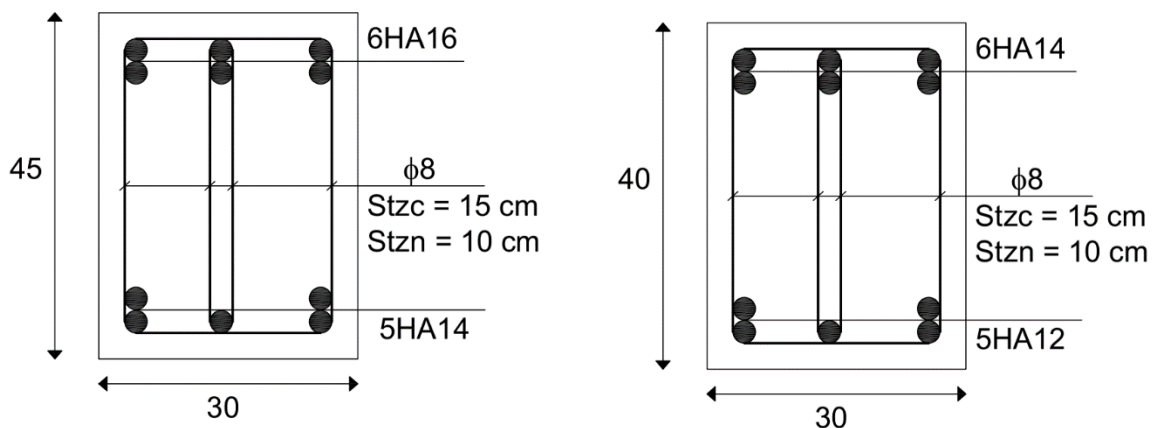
Schémas du ferrailage de la poutre principale et la poutre secondaire.
